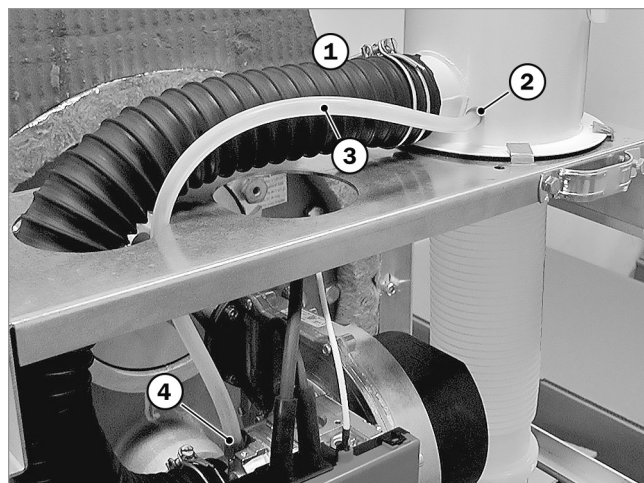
Zuluft- und Druckausgleichs-Schlauch aufstecken
